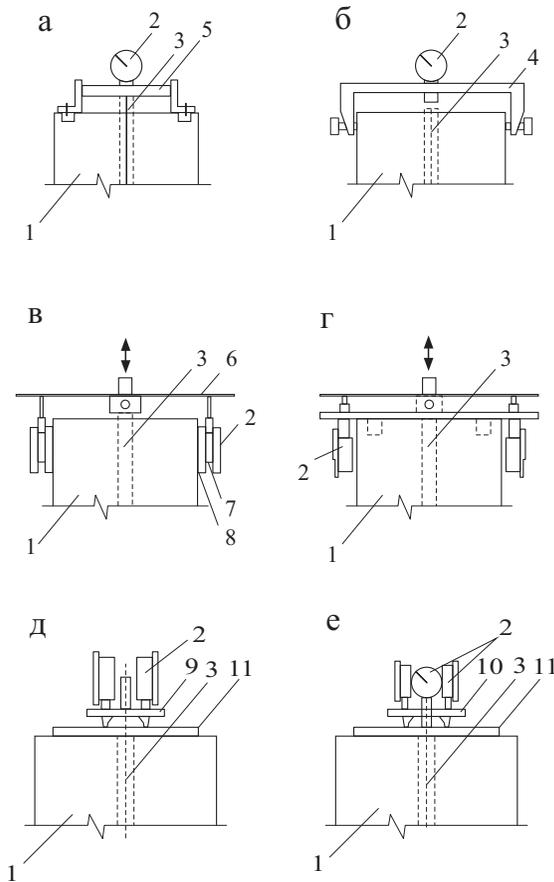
Схемы испытания сцепления арматуры с бетоном:
